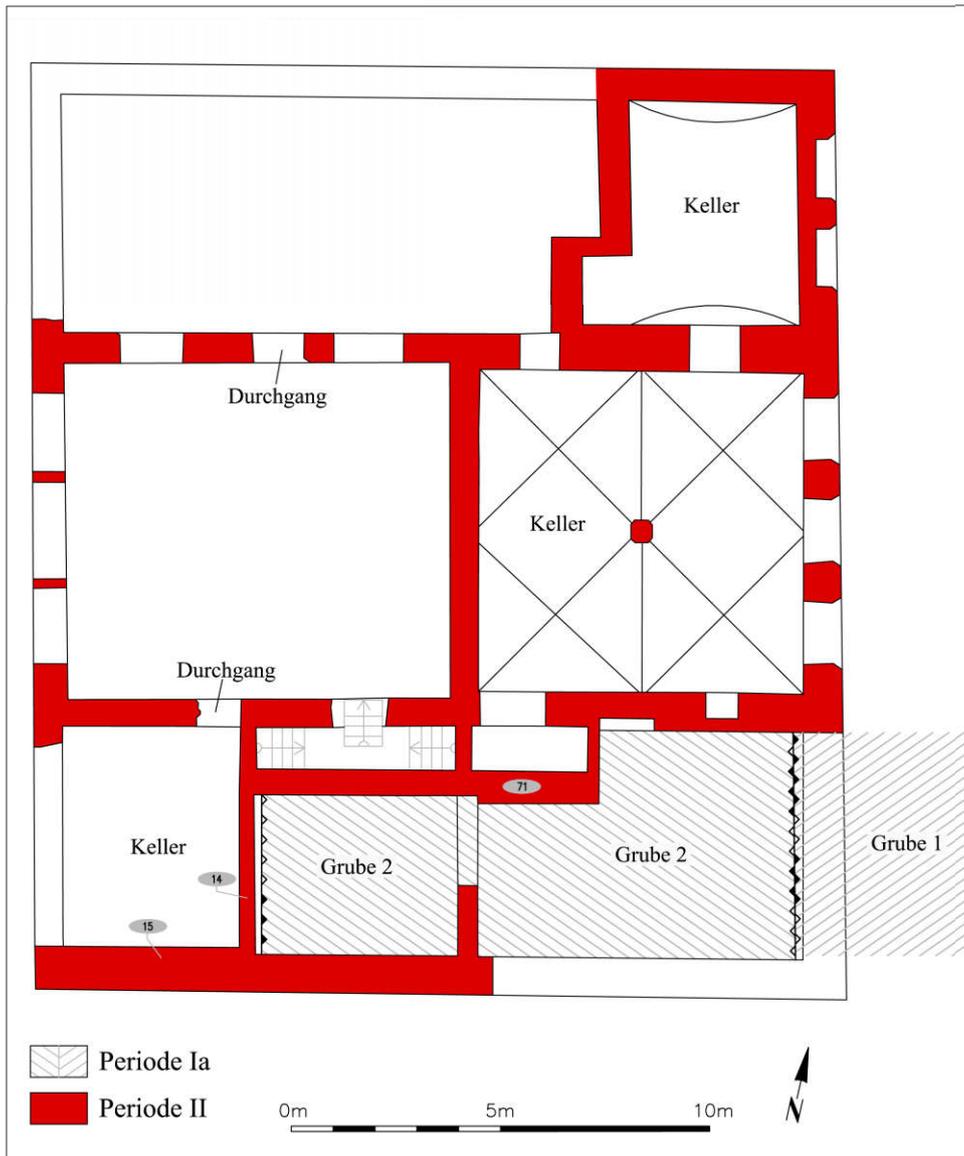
Hansestadt Lübeck, Schloss Rantzaу, Parade 1. Grundriss der mittelalterlichen Domkurie (Periode II).
